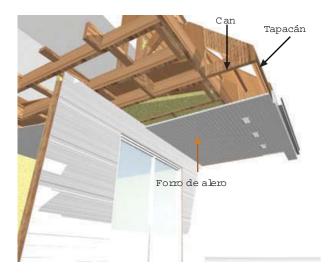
Vista de un alero recto, donde se muestran los elementos que lo componen.
